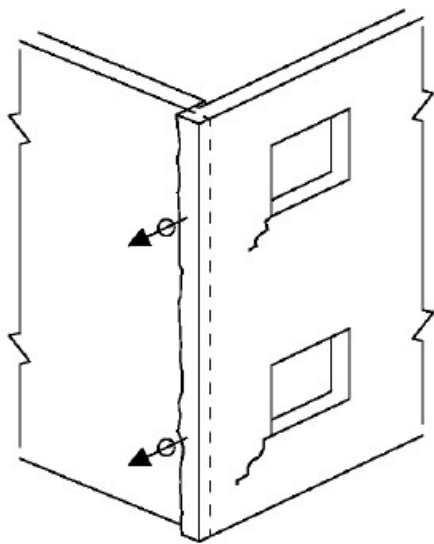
Приклад відшарування лицьової кладки фасаду
